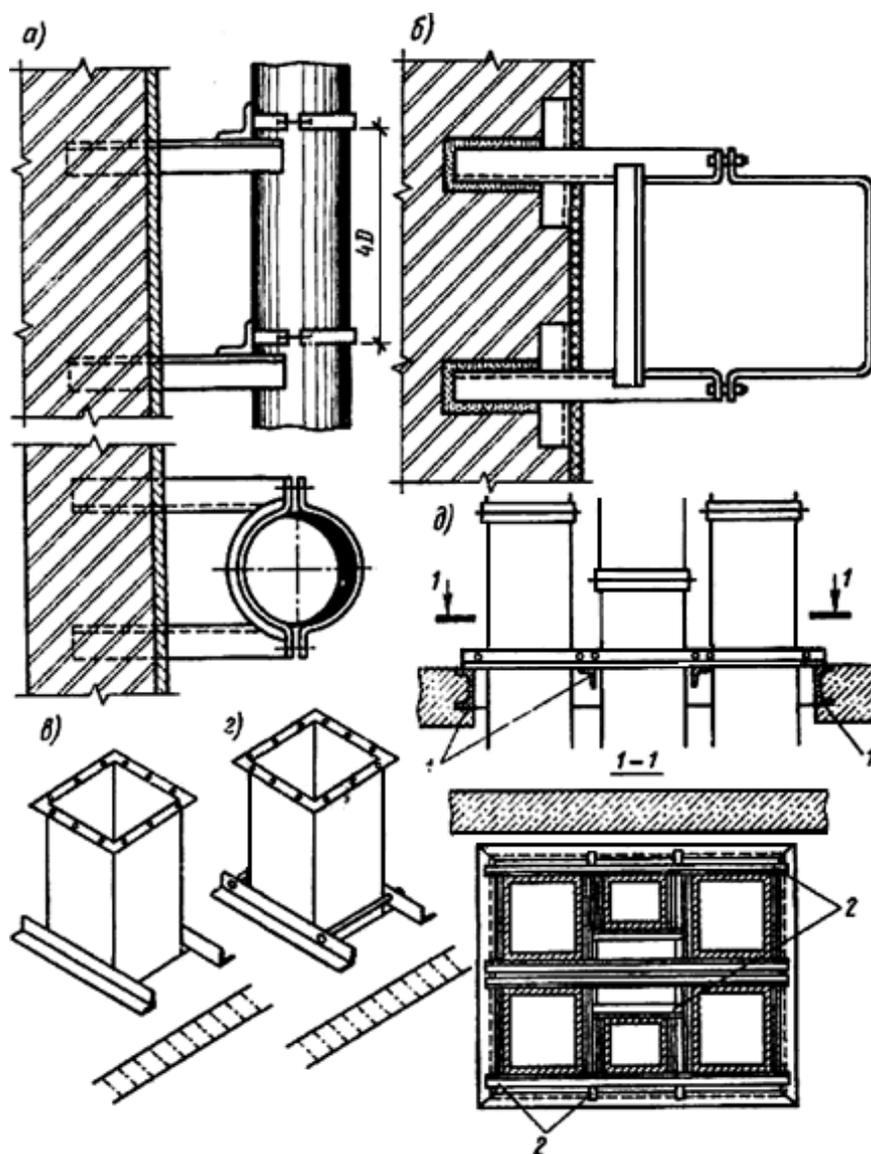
Конструкция крепления стальных вертикальных воздуховодов: а - круглого сечения; б - квадратного сечения; в - квадратного сварного; г - квадратного фальцевого; д - группы вертикальных воздуховодов; 1 - закладная рама; 2 - детали крепления
